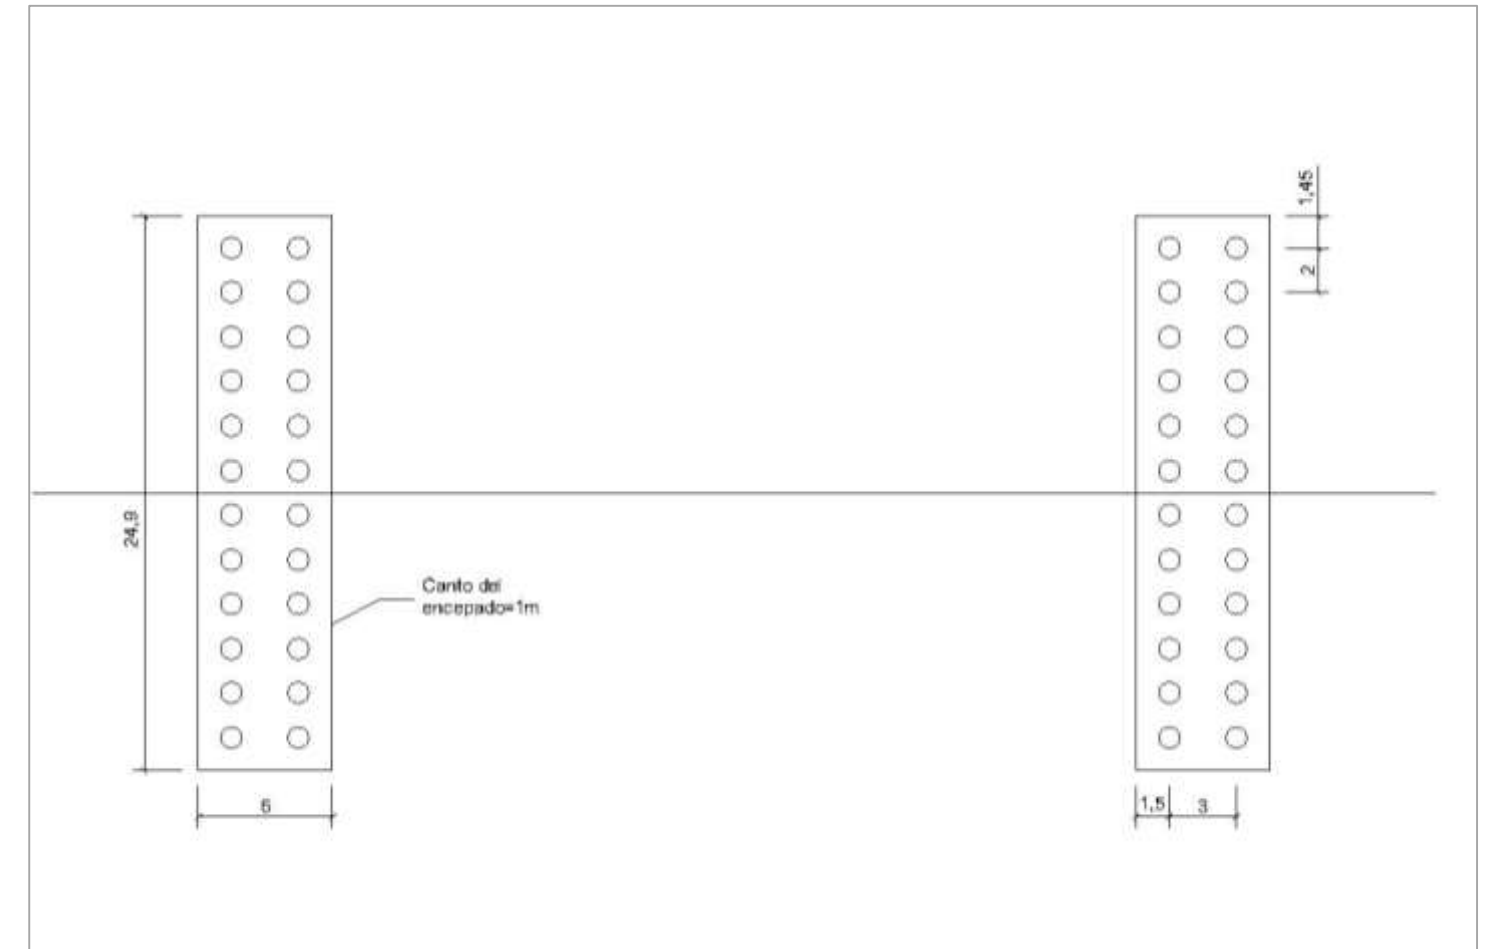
Imagen sobre la planta de encepados para la visualización de los pilotes de 1 m de diámetro y de 15 m de longitud en éstos. Fuente: Elaboración propia con AutoCAD.
